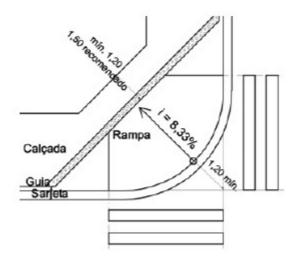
Inclinação do rebaixo de passeio, para travessia de pedestres localizado na esquina
